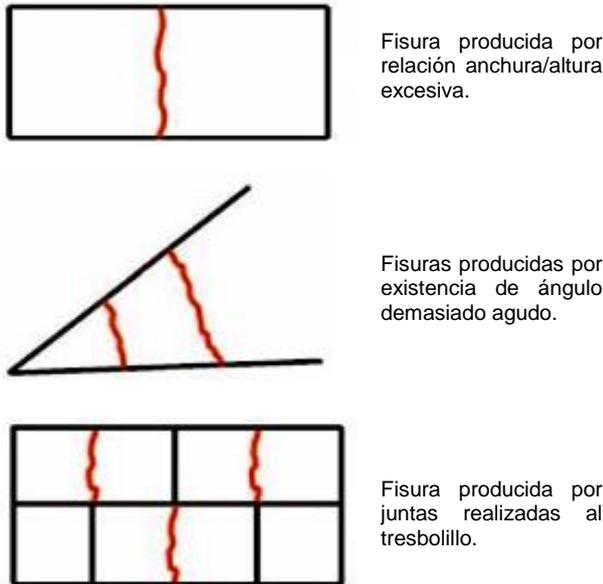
Fisuras habituales causadas por un mal diseño de las juntas de movimiento y dilatación.
